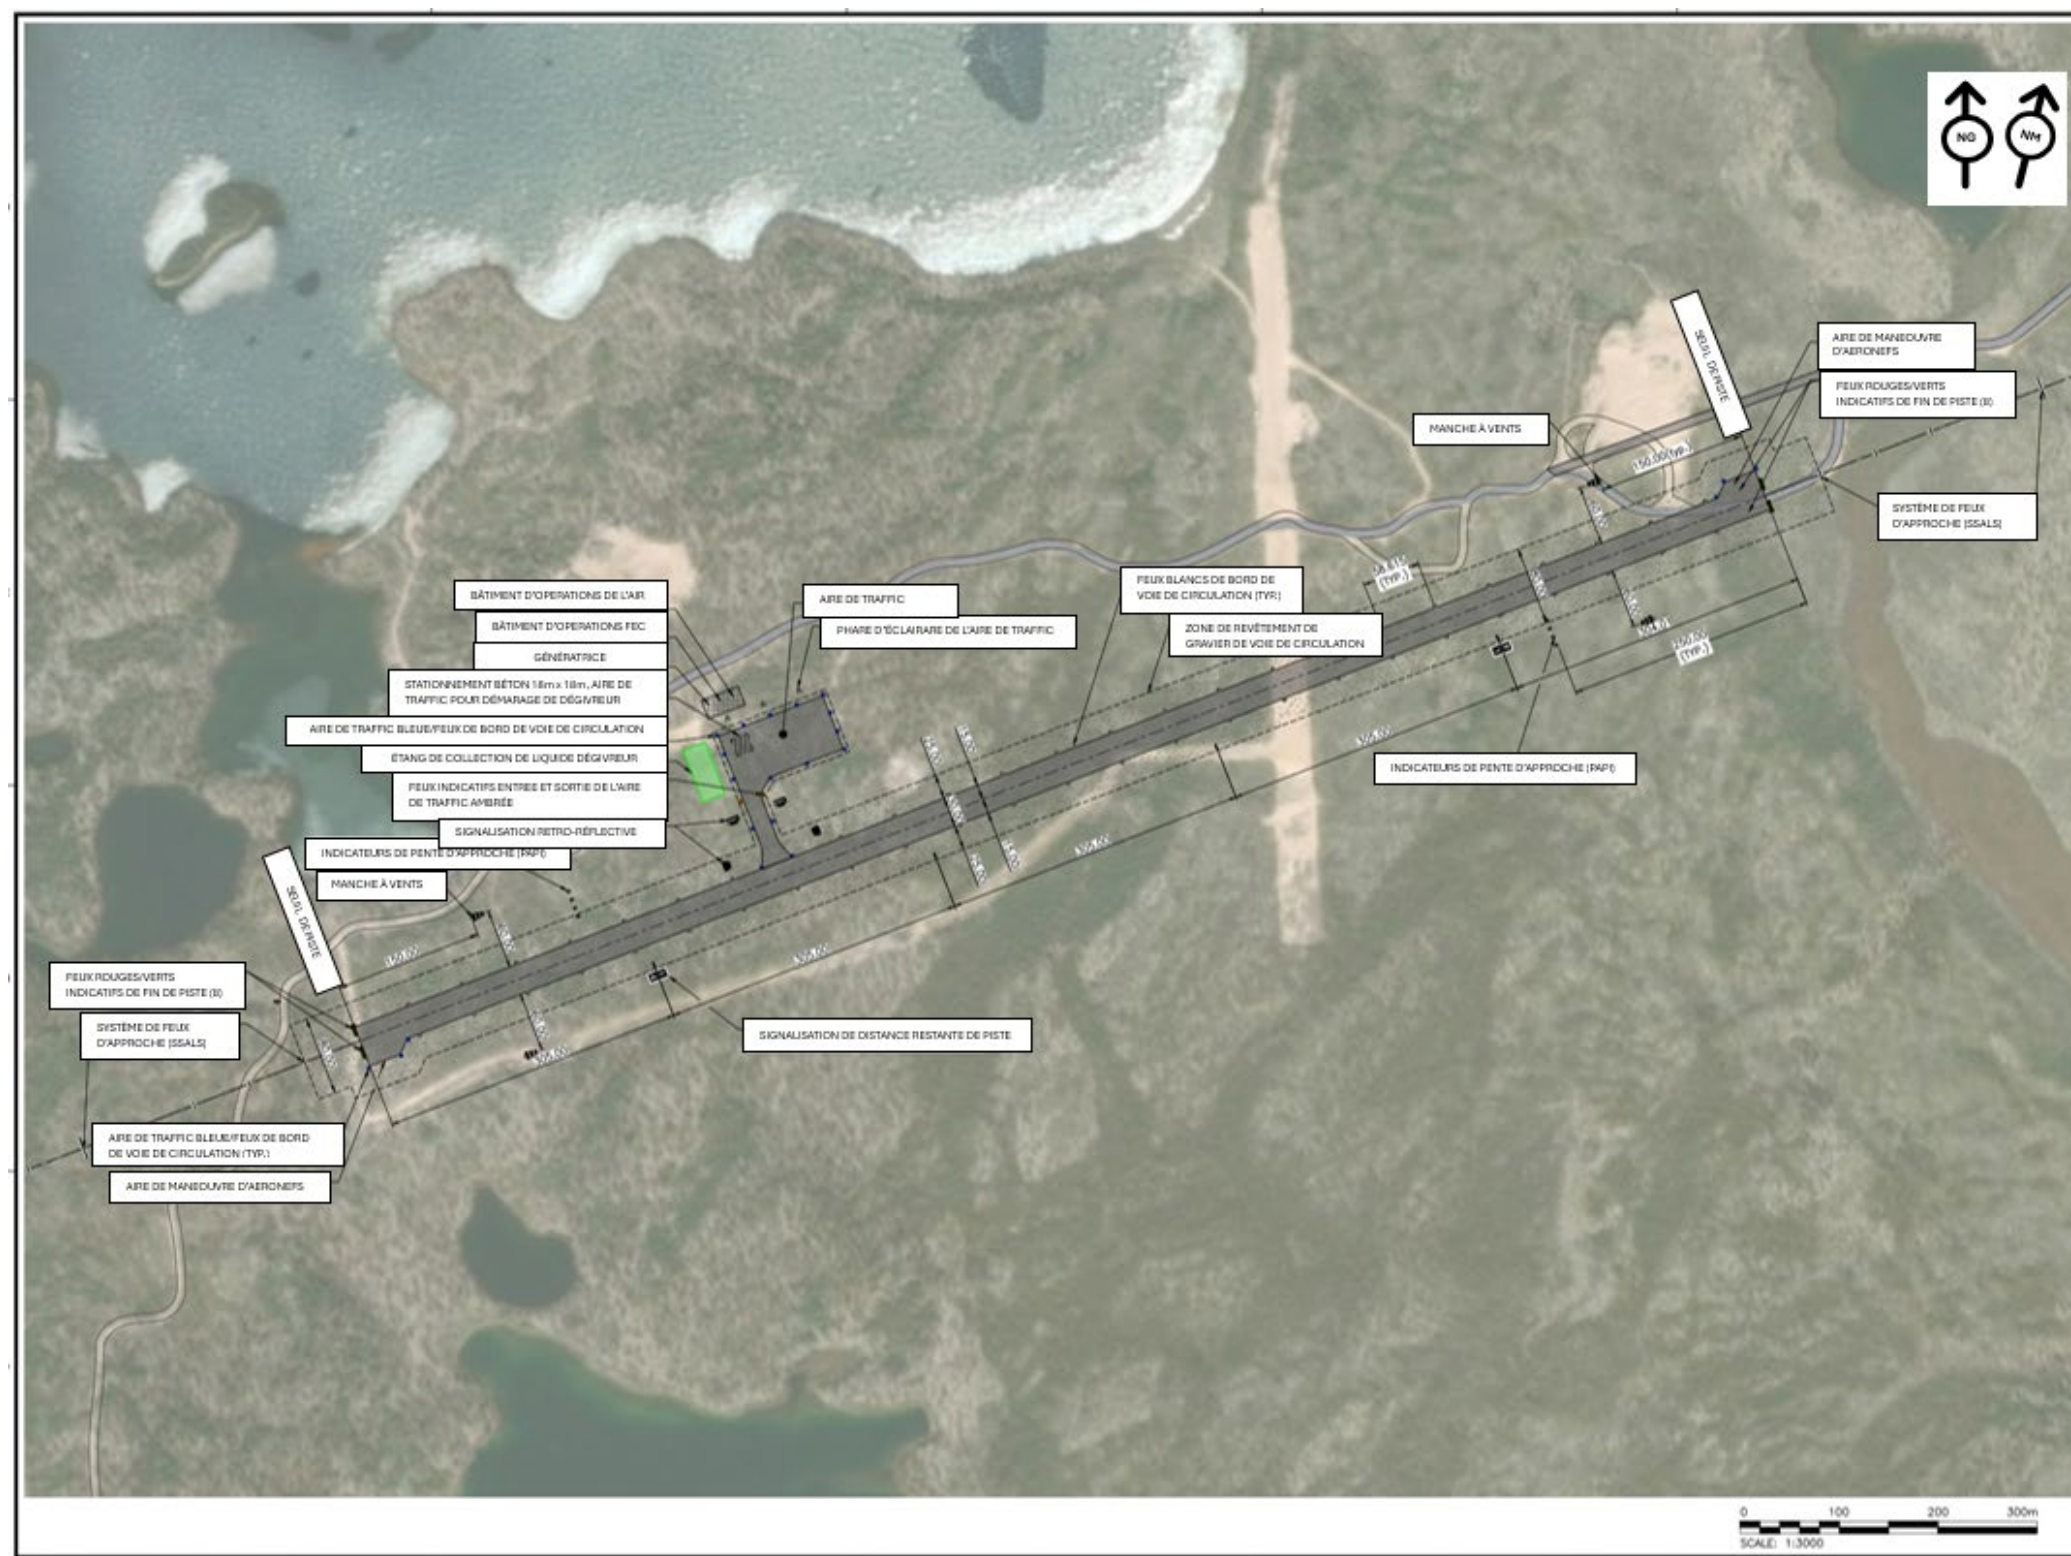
Plan d'ensemble du site (Tetra Tech, 2022)
